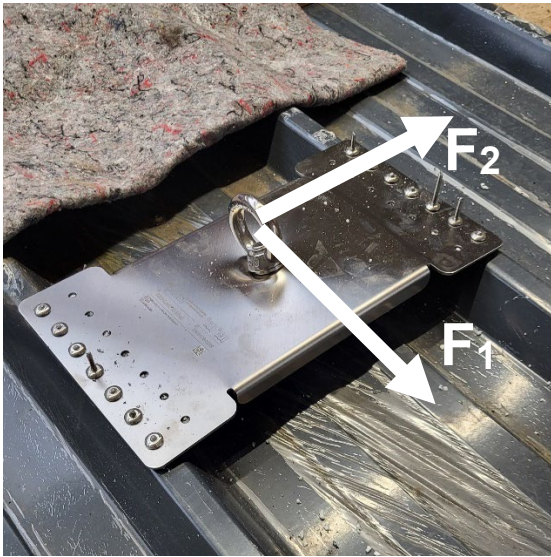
Prüfaufbau 5, Anschlagereinrichtung,
